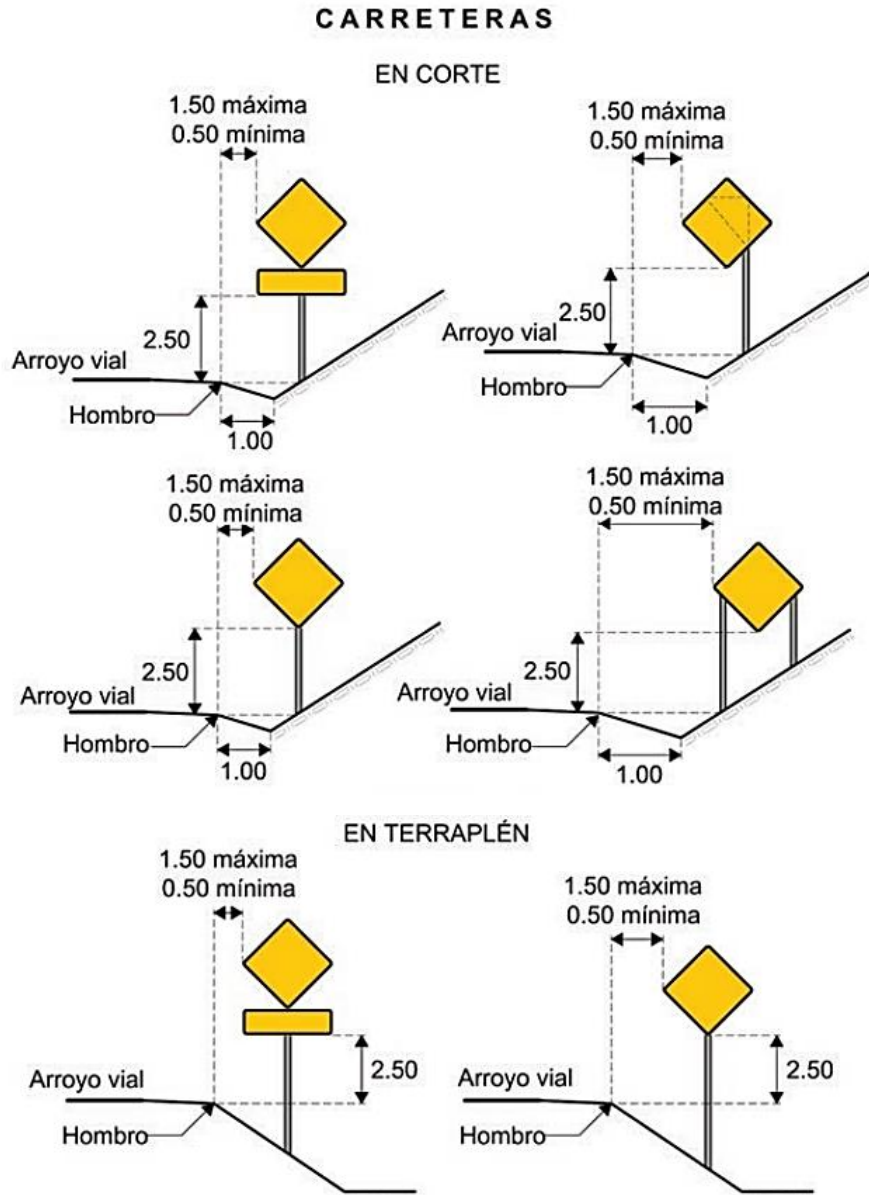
Ubicación de señalamiento preventivo en sección corte y en sección terraplén
